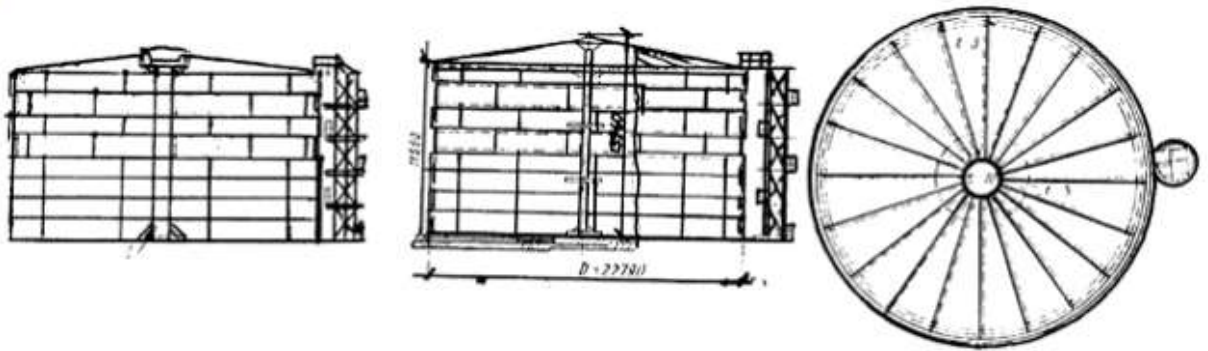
Общий вид вертикального цилиндрического резервуара и щитовой крыши.
